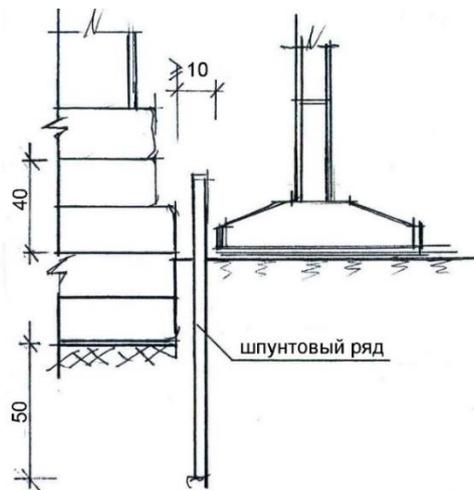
Вариант примыкания новых фундаментов к существующим зданиям
